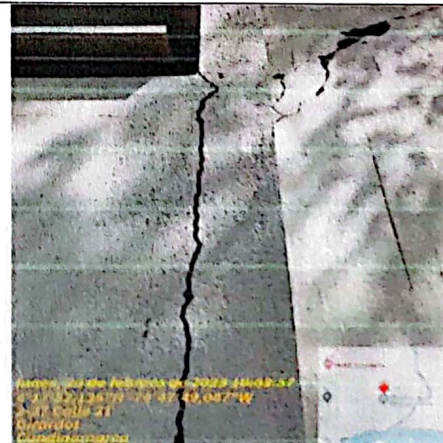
Grietas que atraviesan el espesor de pared
